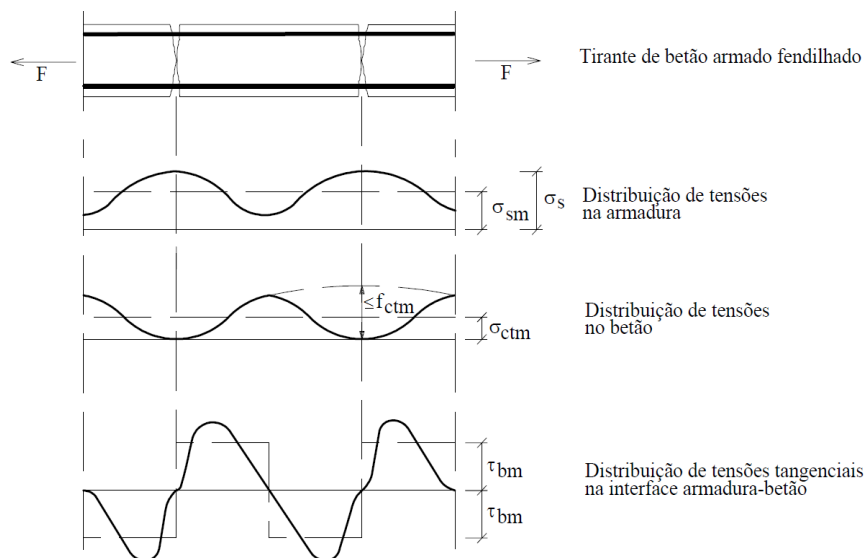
Distribuição de tensões, no betão e na interface armadura-betão, num elemento de betão armado fendilhado. Adaptado de (CEB-Manual, 1985).
